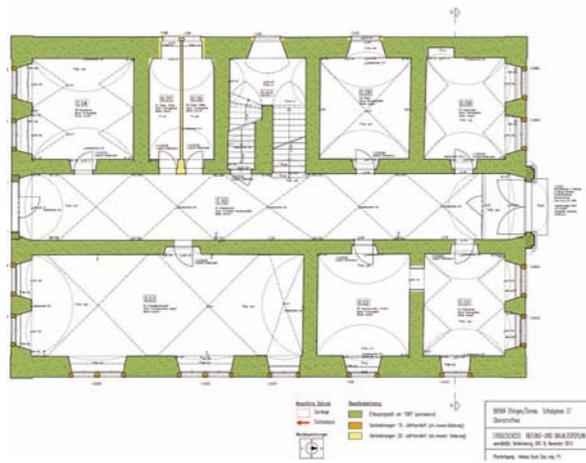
Oberschaffnei, Baualtersplan Erdgeschoss
